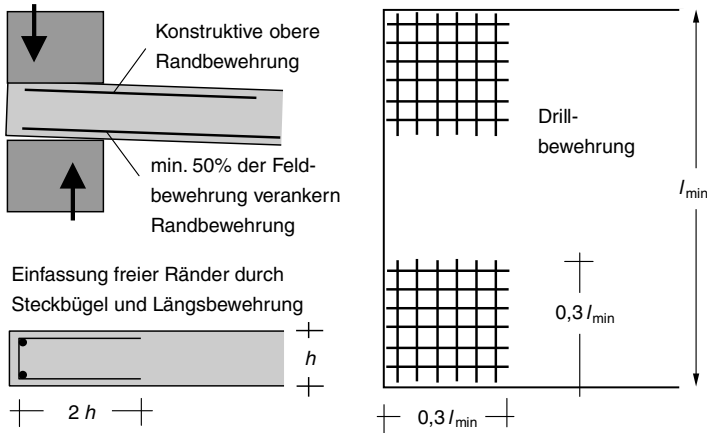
Konstruktionsregeln bei Platten (Drill- und Randbewehrung/Randeinfassung)
